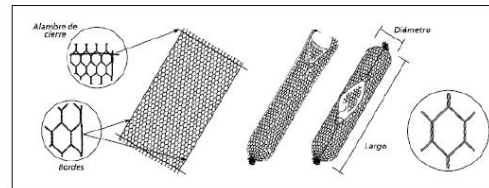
Gavión tipo saco. Fuente: (de Almeida Barros et al. 2010)
